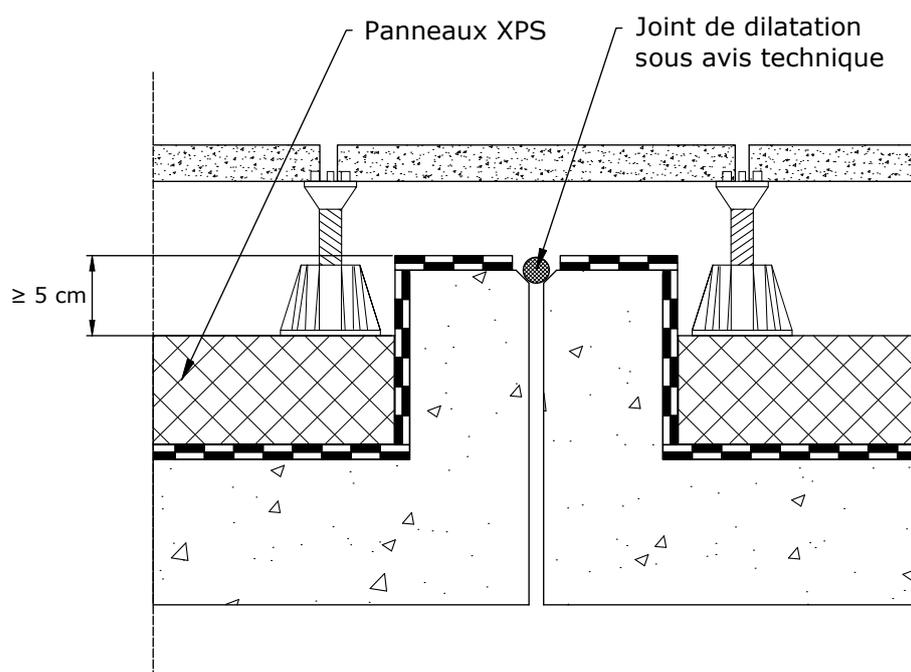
Toiture-terrasse accessible aux piétons avec protection par dalles sur plots - Joint plat surélevé - Exemple
